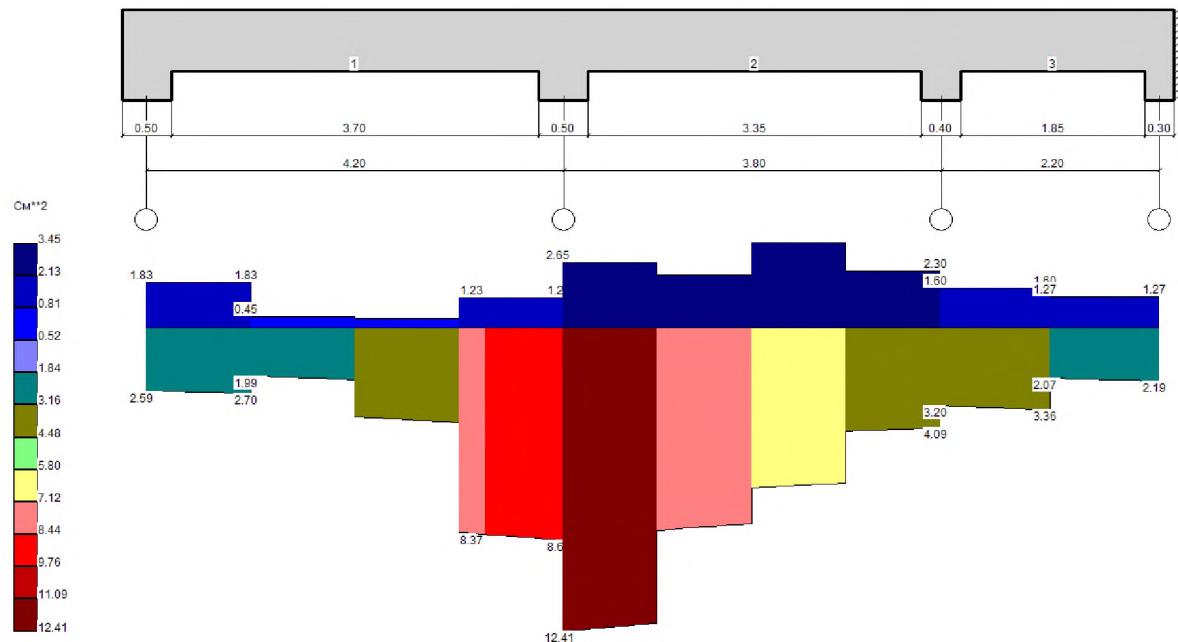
Балка № 6. Епюра поперечного армування
